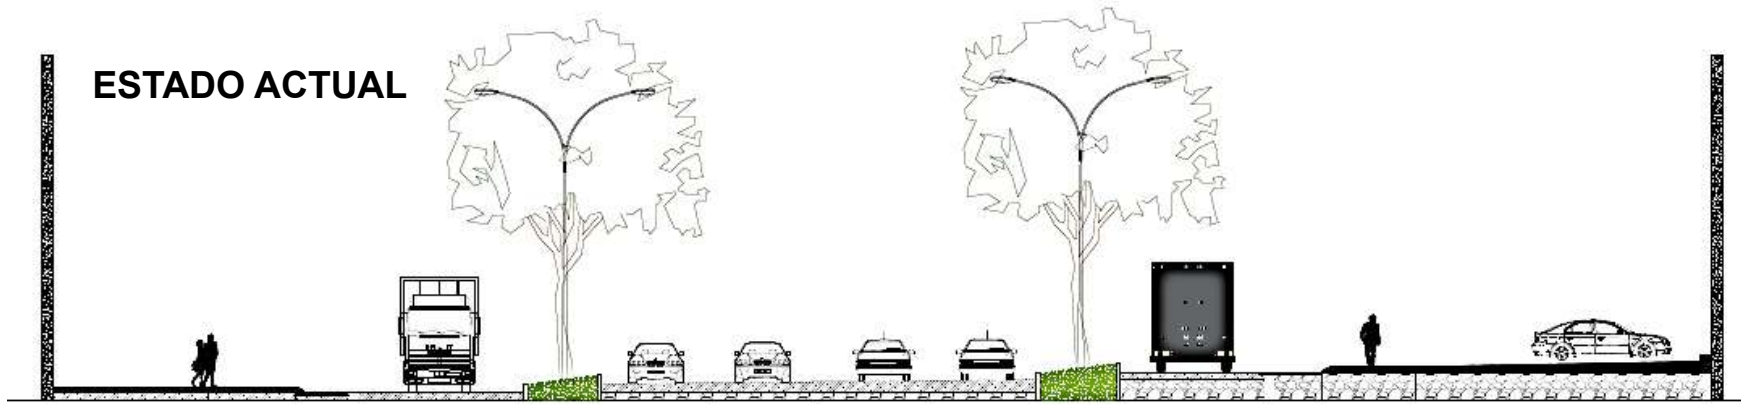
Sección actual de Av. Madero Poniente con calle Loma Dorada
